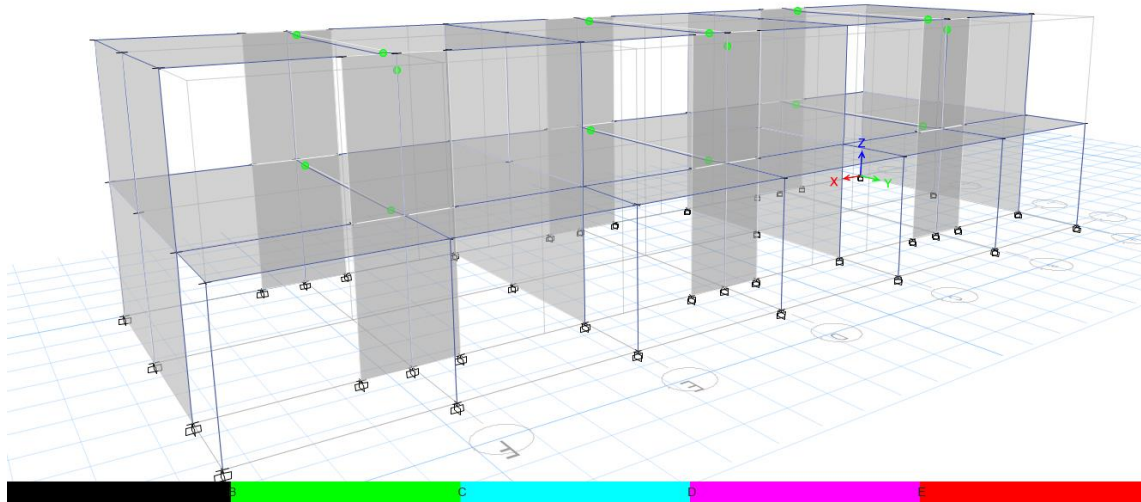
Rotulas plásticas en un desplazamiento de 0.85 cm.
